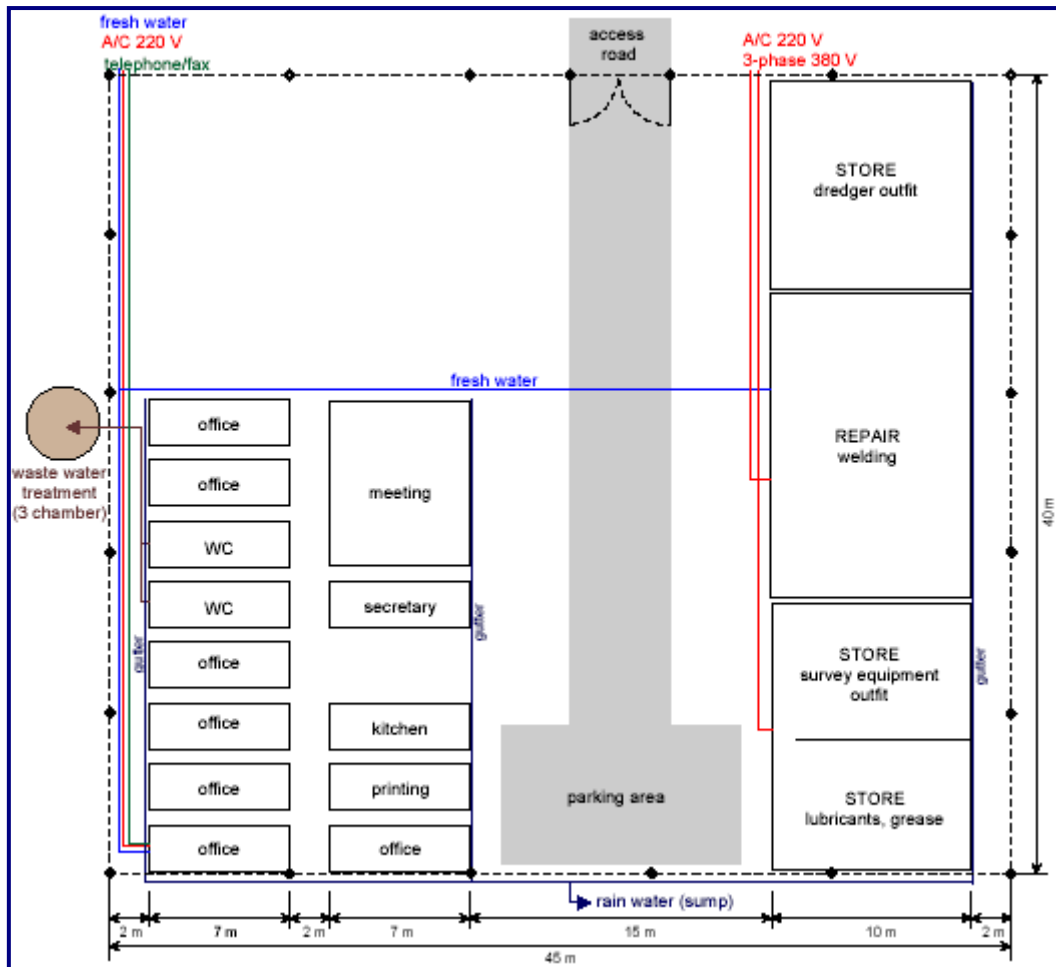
Layout do Canteiro de dragagem e terraplanagem
